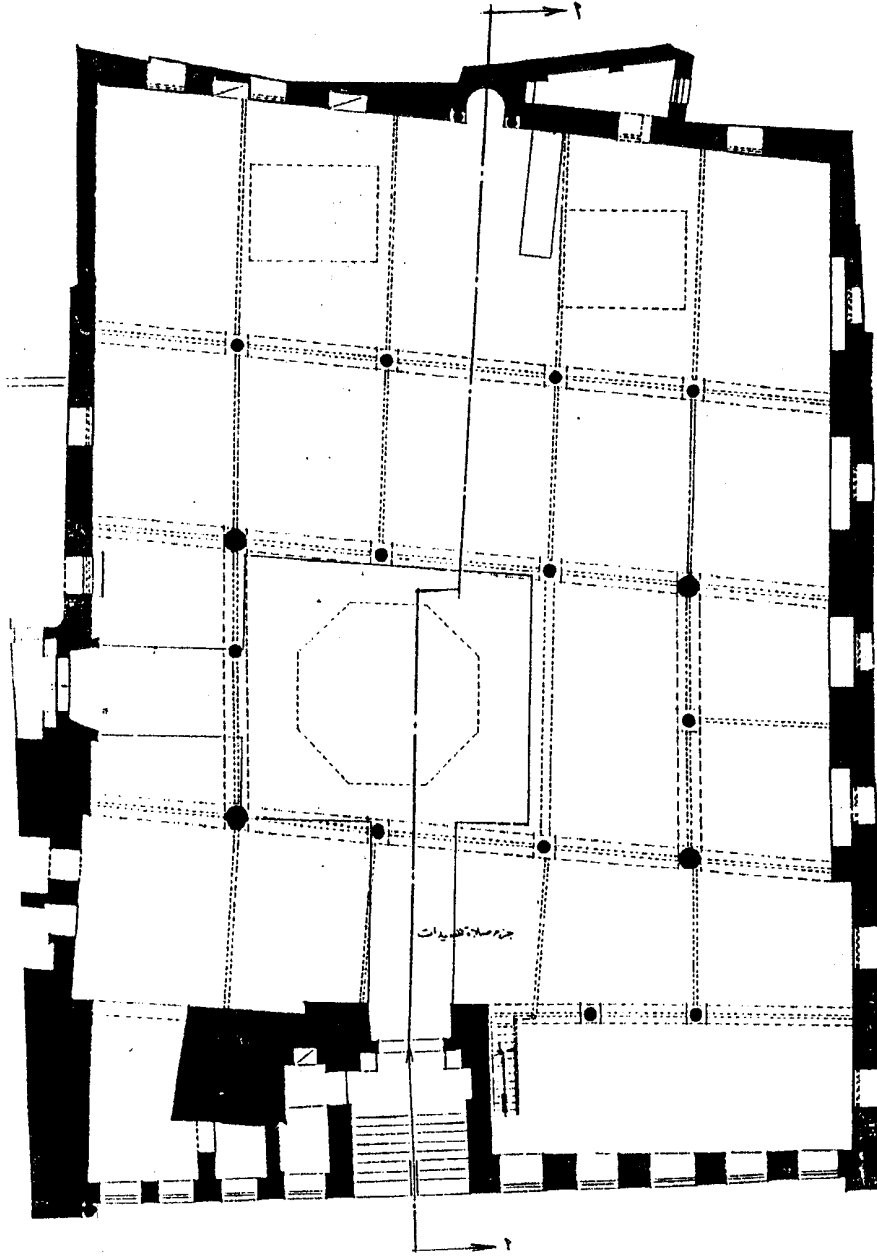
مسقط أفقي لجامع جنبلات بالقاهرة (عن محمود الحسيني)
